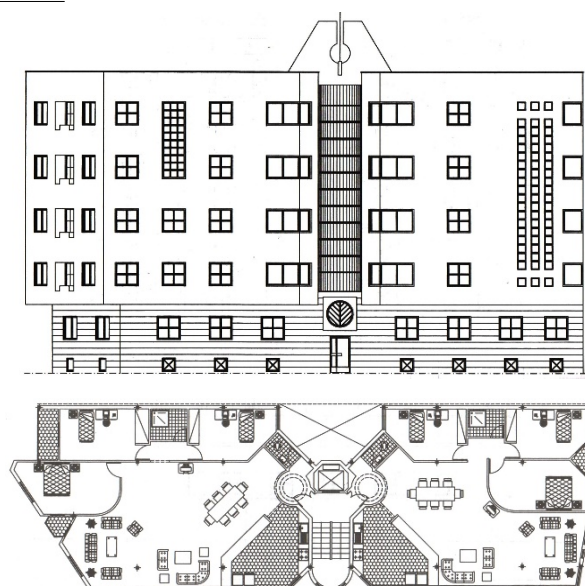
Фасад и план жилого дома с двумя квартирами на этаже. Размещение на перекрестке (Тегеран)
